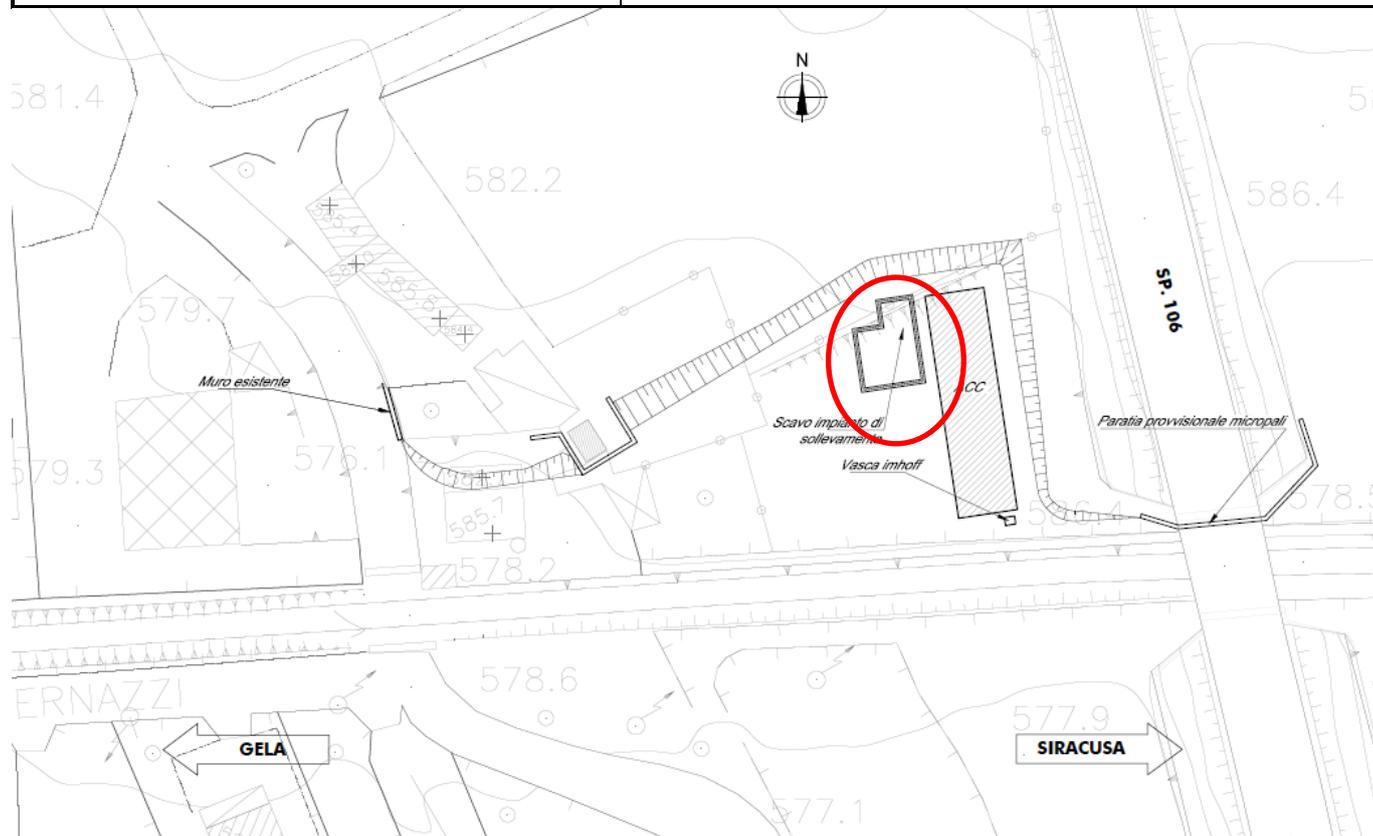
Estratto planimetria generale – posizione vasca impianto di sollevamento indicata in rosso
